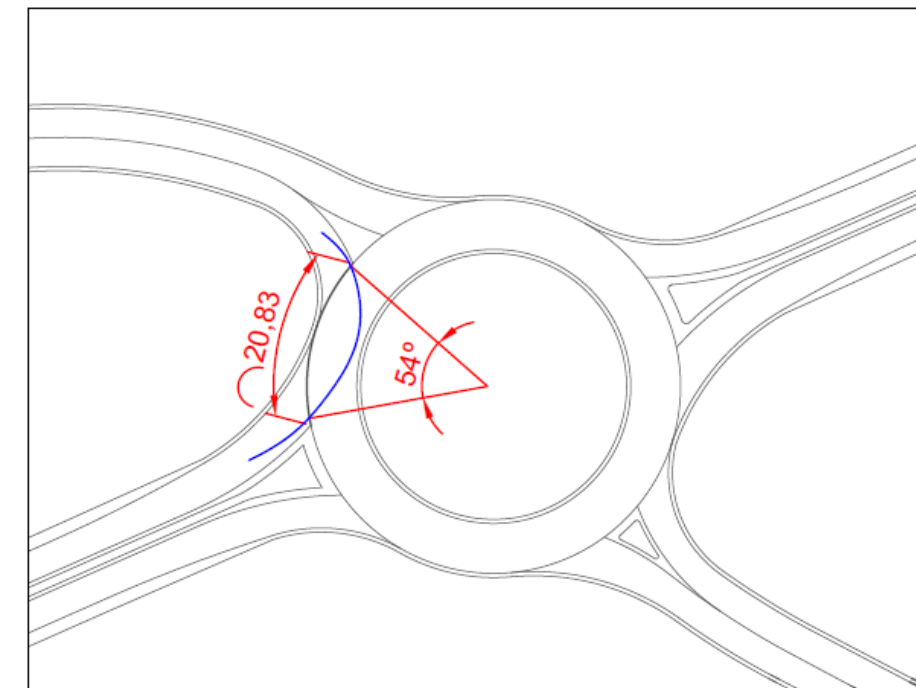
Dibujo en planta de la glorietta principal indicando la separación y el ángulo subtendido al centro de la glorietta de la entrada y la salida contiguas más desfavorables. Fuente: elaboración propia.
